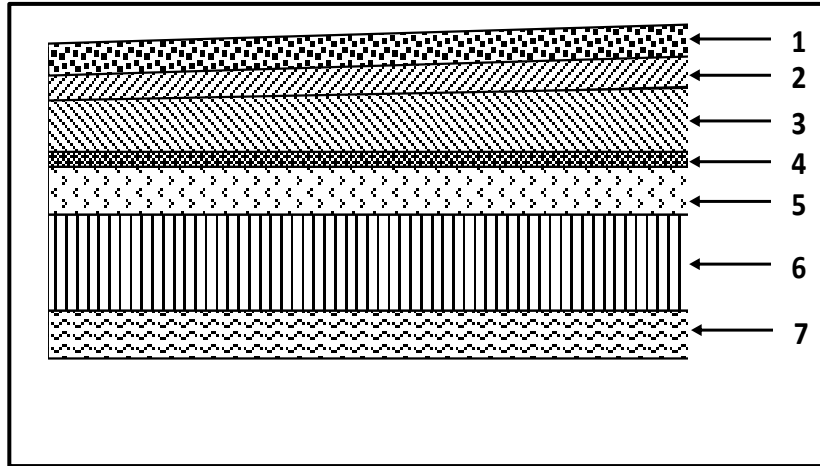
a: Eléments constituant le plancher-terrasse.
